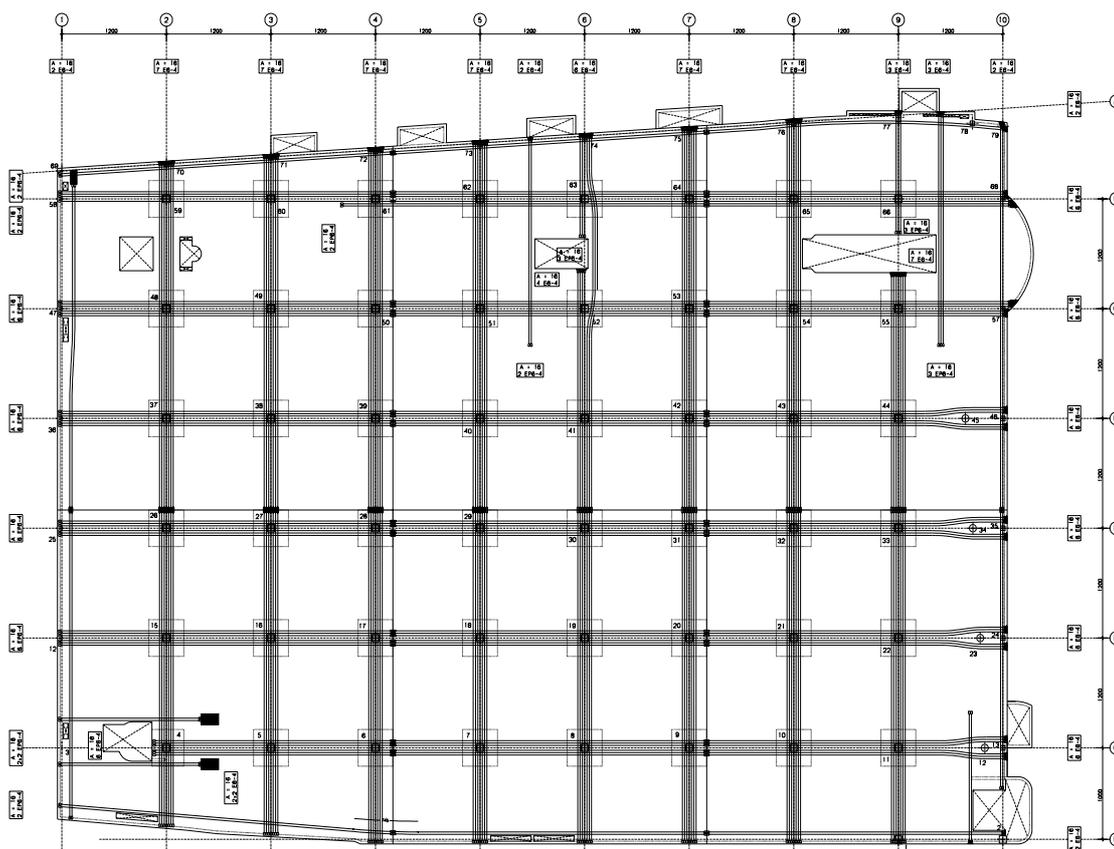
Distribución en planta de los tendones de pretensado del primer nivel.
